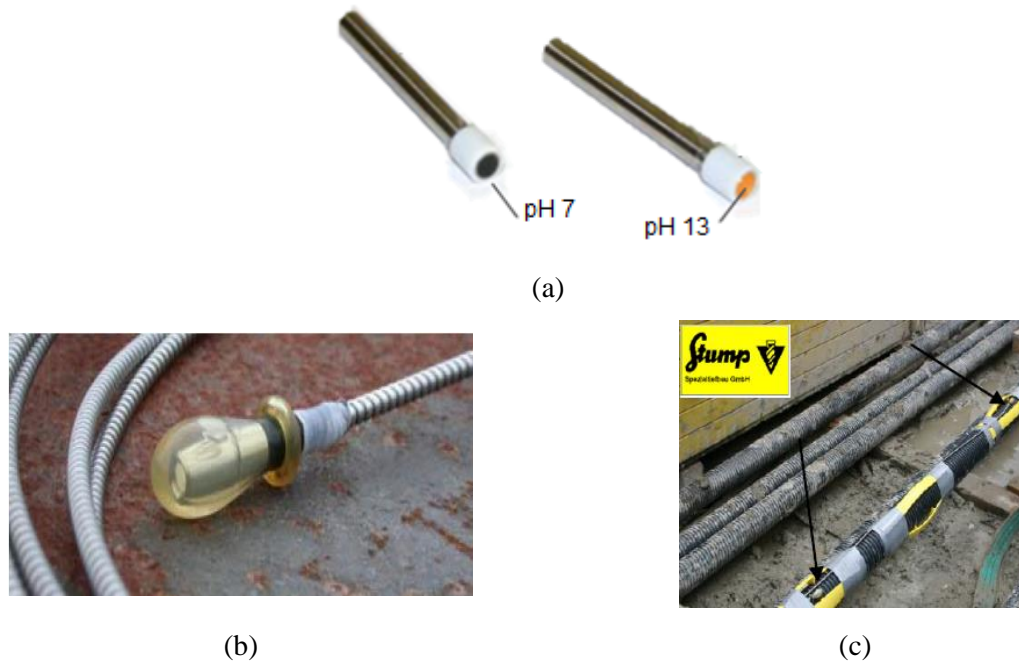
Sensor de pH colorimétrico [102]: a) Aspecto físico; b) pequena camada estanque c) Instalação em ancoragens pré-fabricadas.
